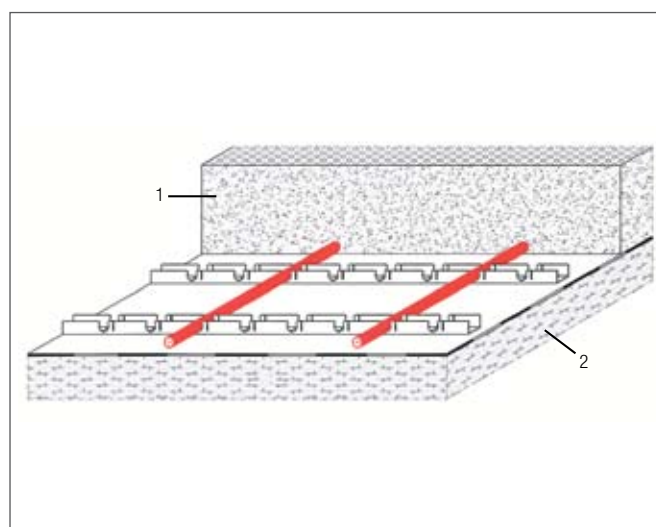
Placă de pardoseală armată cu ace; construcție standard – țevile de încălzire montate pe șine cu cleme
